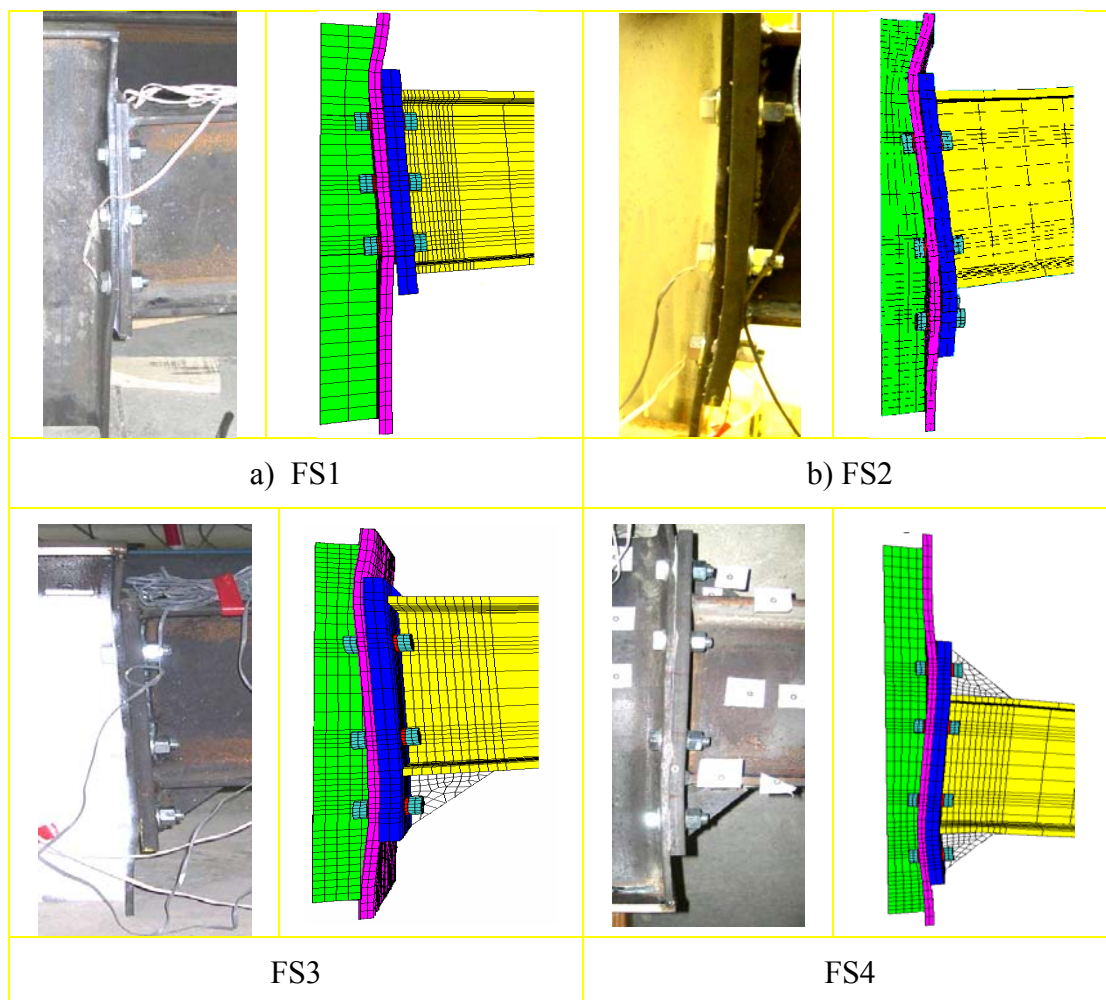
Déformées des assemblages poteau-poutre (essais/modèle)
